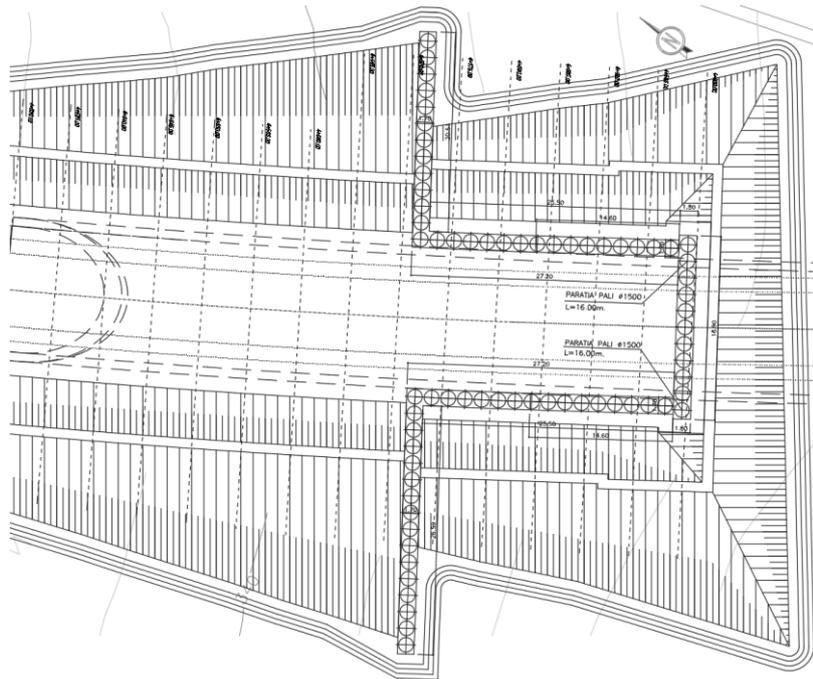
Stralcio planimetrico imbocco A (Lato Nord)
